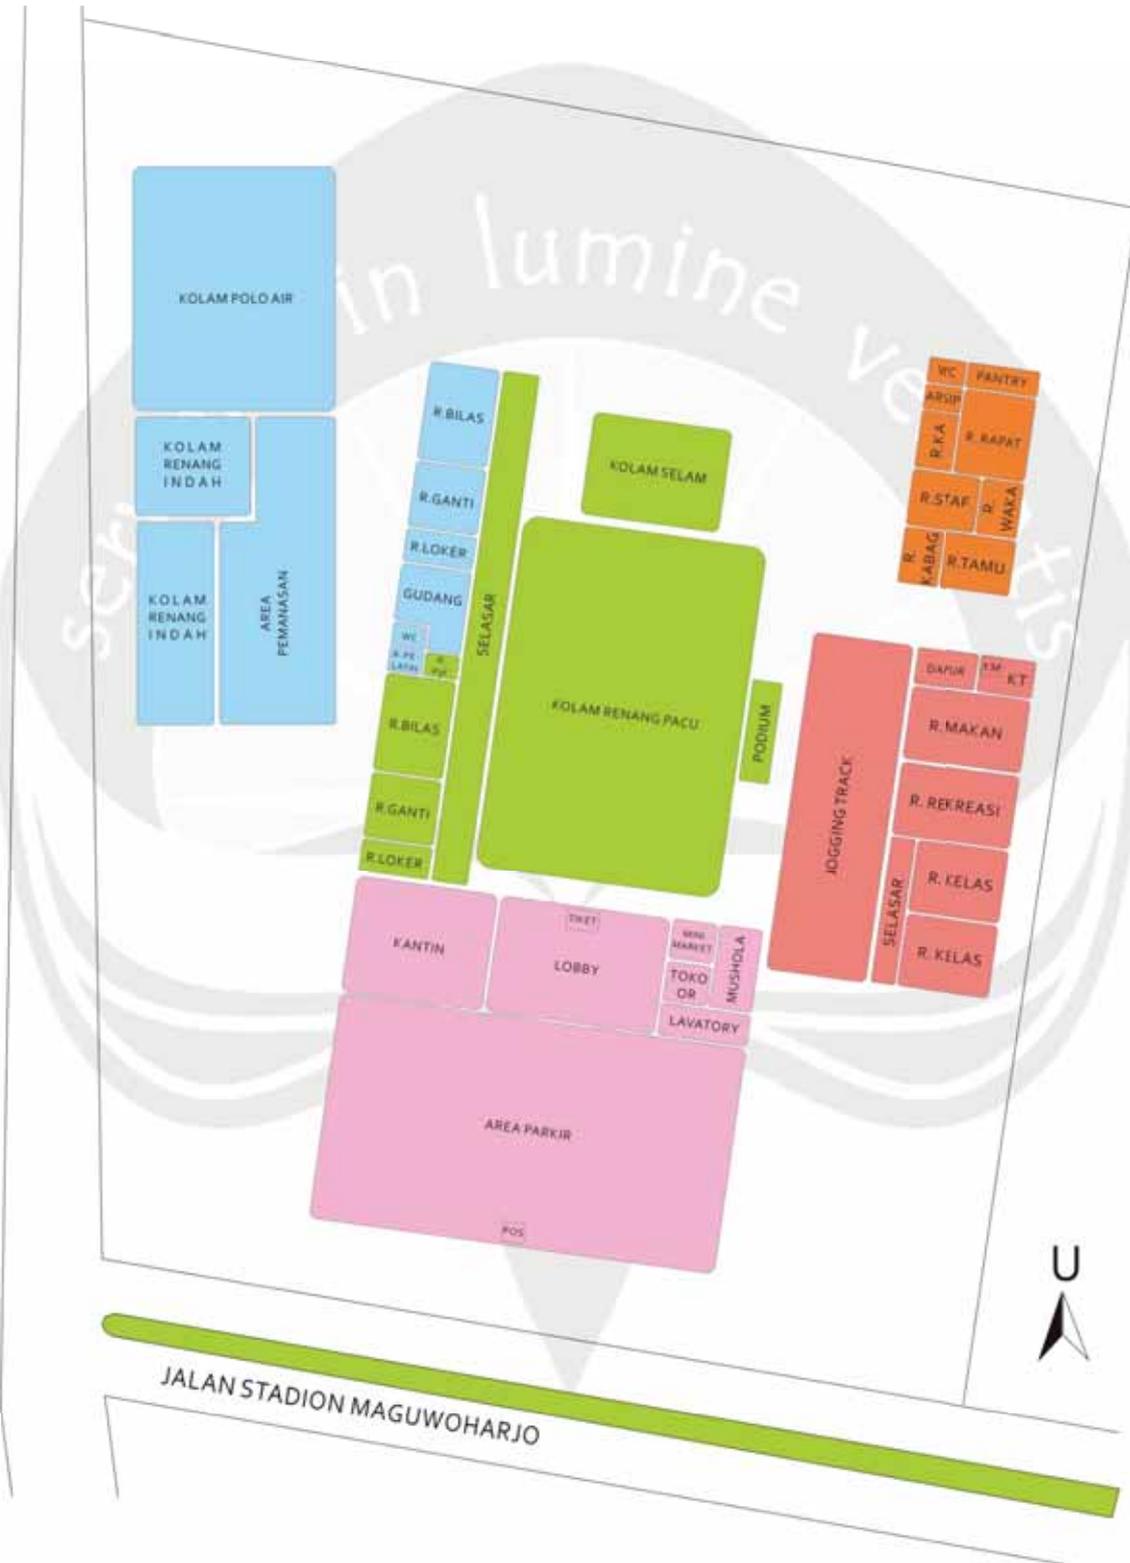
8. Konsep Organisasi Ruang Mikro pada Lantai 2
